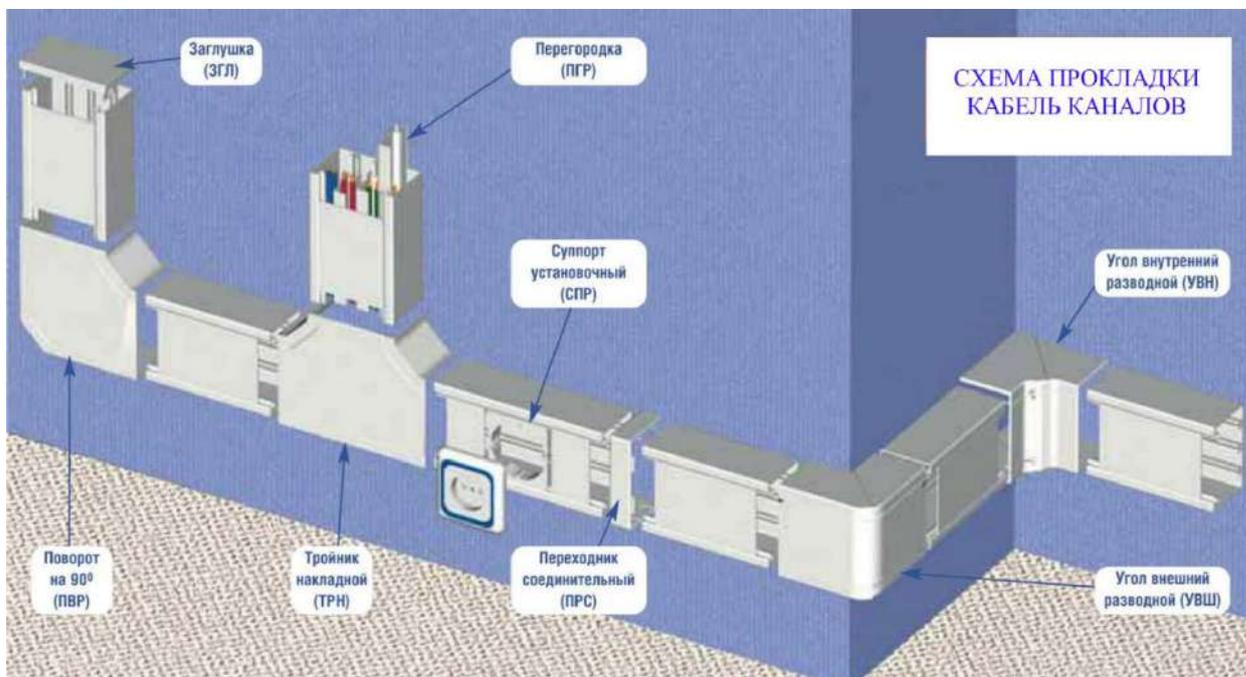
Схема открытого способа прокладки провода в кабель-каналах.
